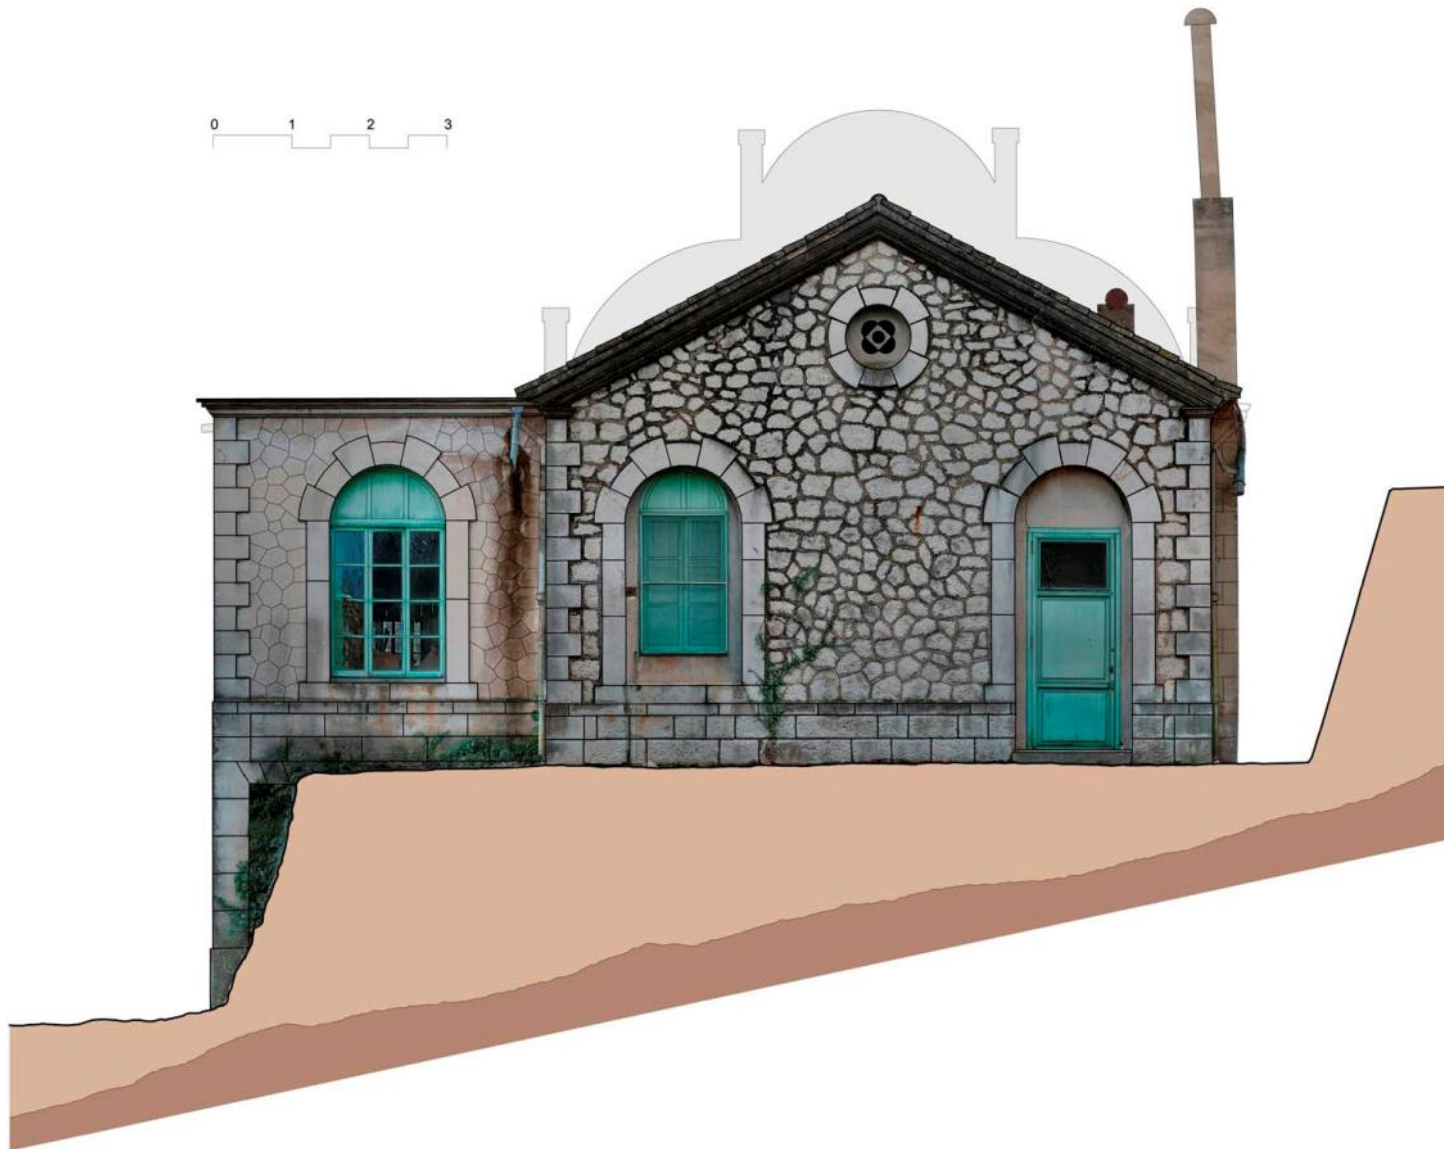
Alzado fachada posterior Norte. Fotoplano y Levantamiento planimétrico.
